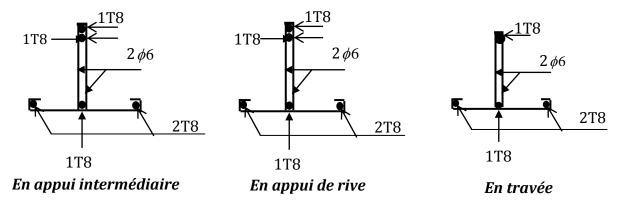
Schémas de Ferraillage des Poutrelles de la terrasse inaccessible
